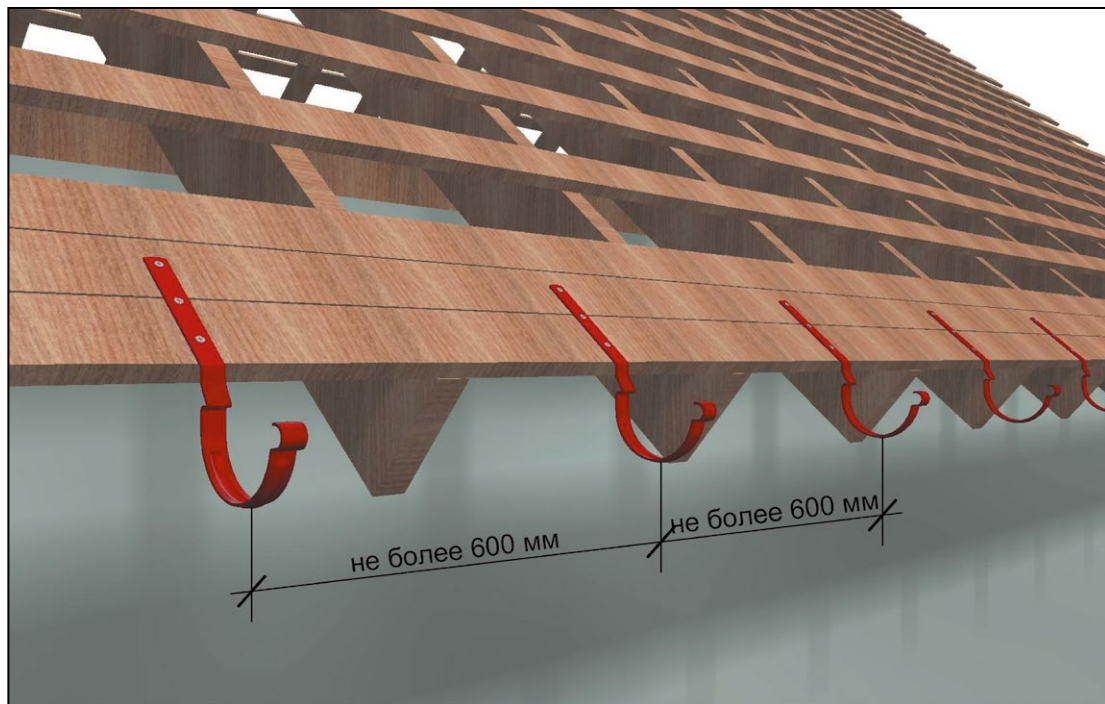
Шаг крюков с креплением на несущую конструкцию кровли
